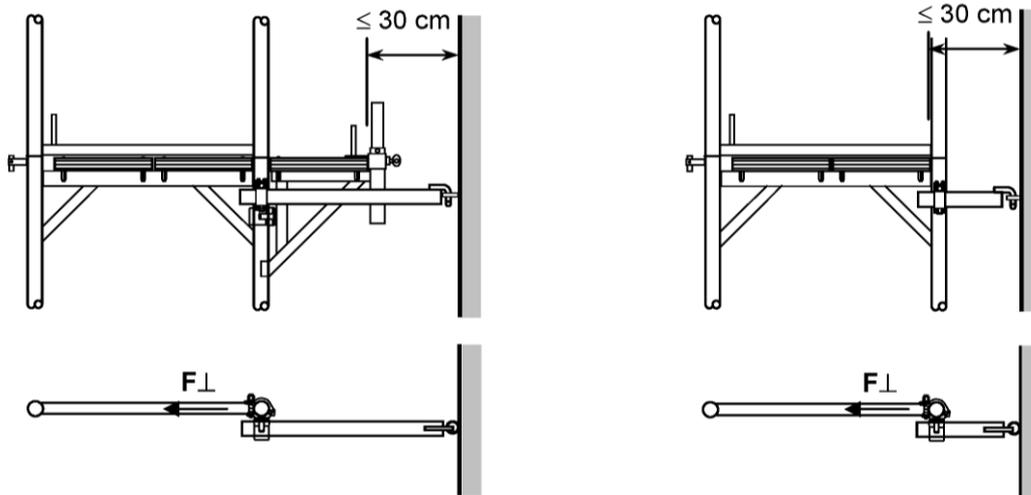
Höhenlage der Gerüsthalter bei Anschluss im „Knoten“
